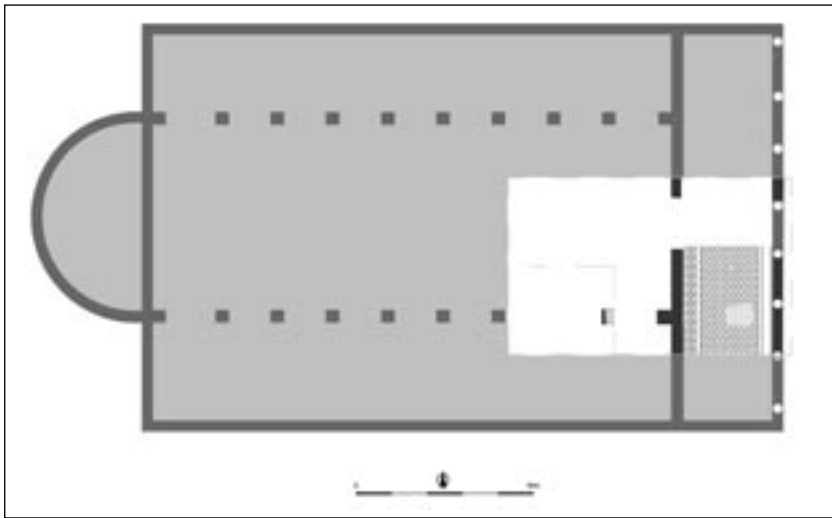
Ricostruzione planimetrica della chiesa presabiniana (elaborazione M.G. Sibilano).
